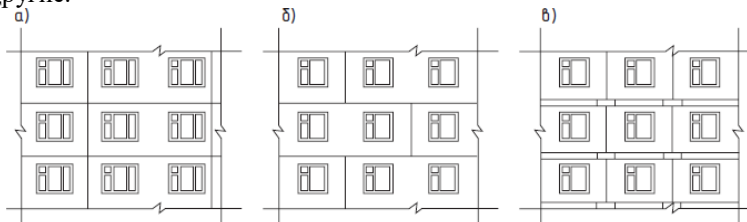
Разрезка наружных стен крупнопанельных зданий: а) однорядная разрезка сквозными вертикальными и горизонтальными швами; б) однорядная разрезка с поэтажной перевязкой; в) двухрядная разрезка с перевязкой панелей поэтажными монтажными поясами.
